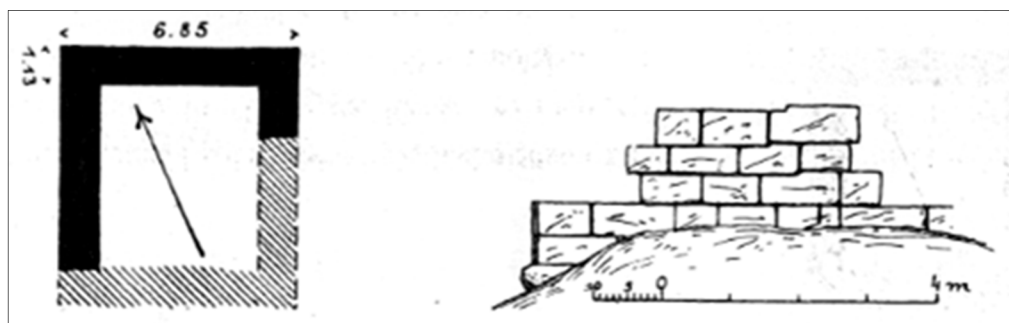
Plan et relevé pierre à pierre d'un mur (ouest ?) de la tour (HILLER et LATTERMANN *Hira*, 1911, p. 38 Fig. 12)
